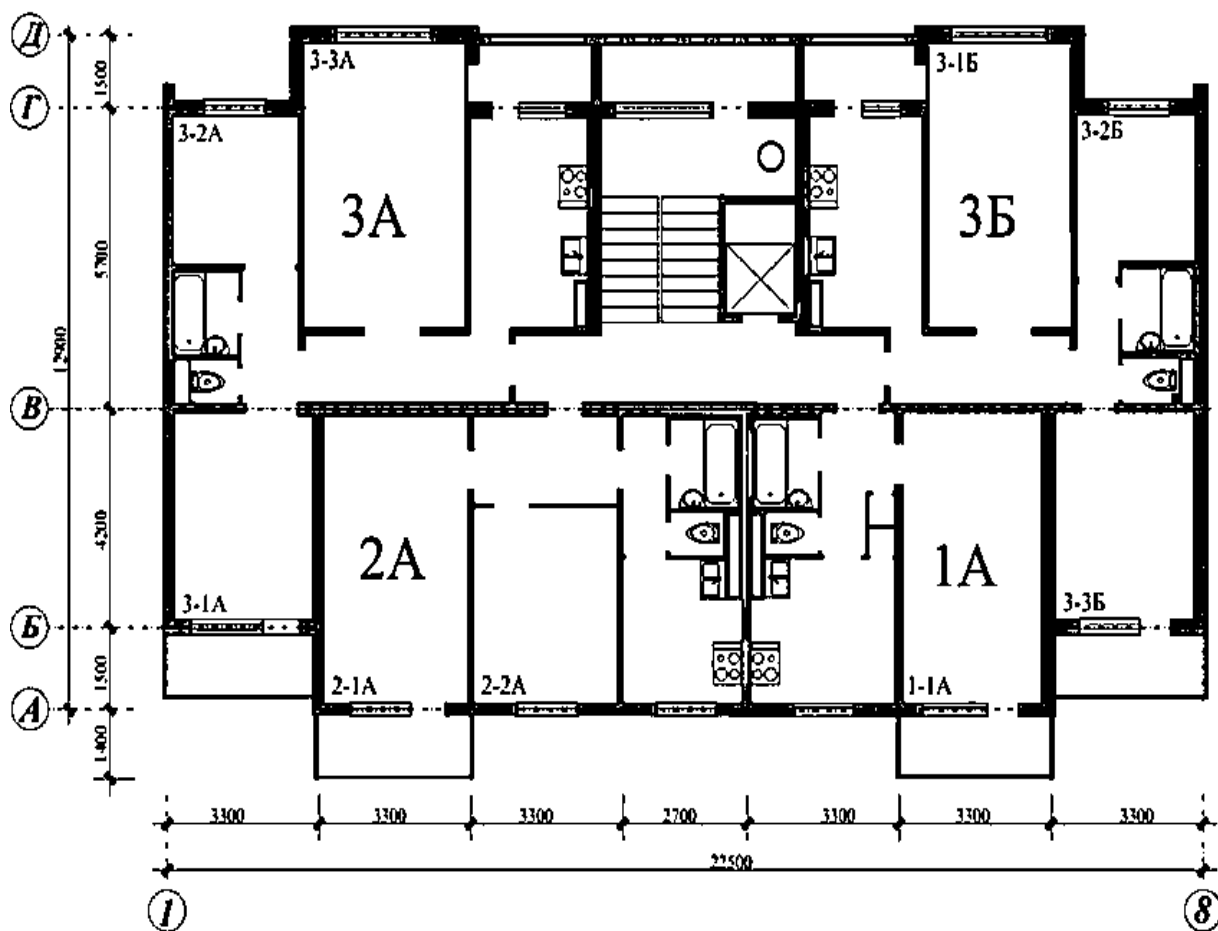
Скорректированная блок-секция здания A с балконами вместо лоджий на южном фасаде  $\Phi_2$  (по оси «А»).
